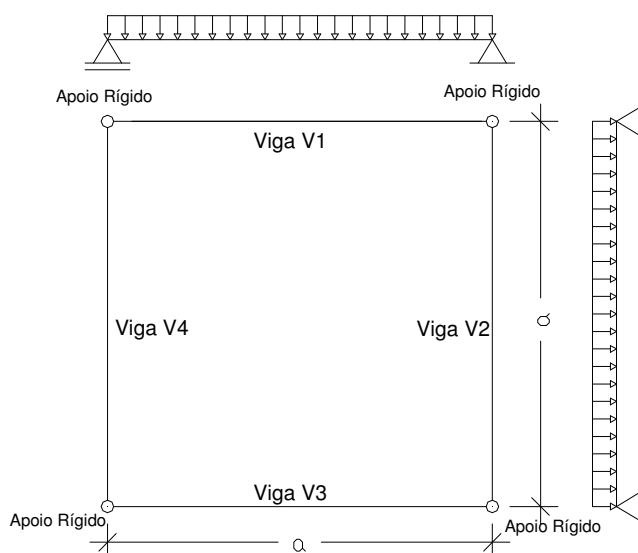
Placa Apoiada em Vigas Elásticas
